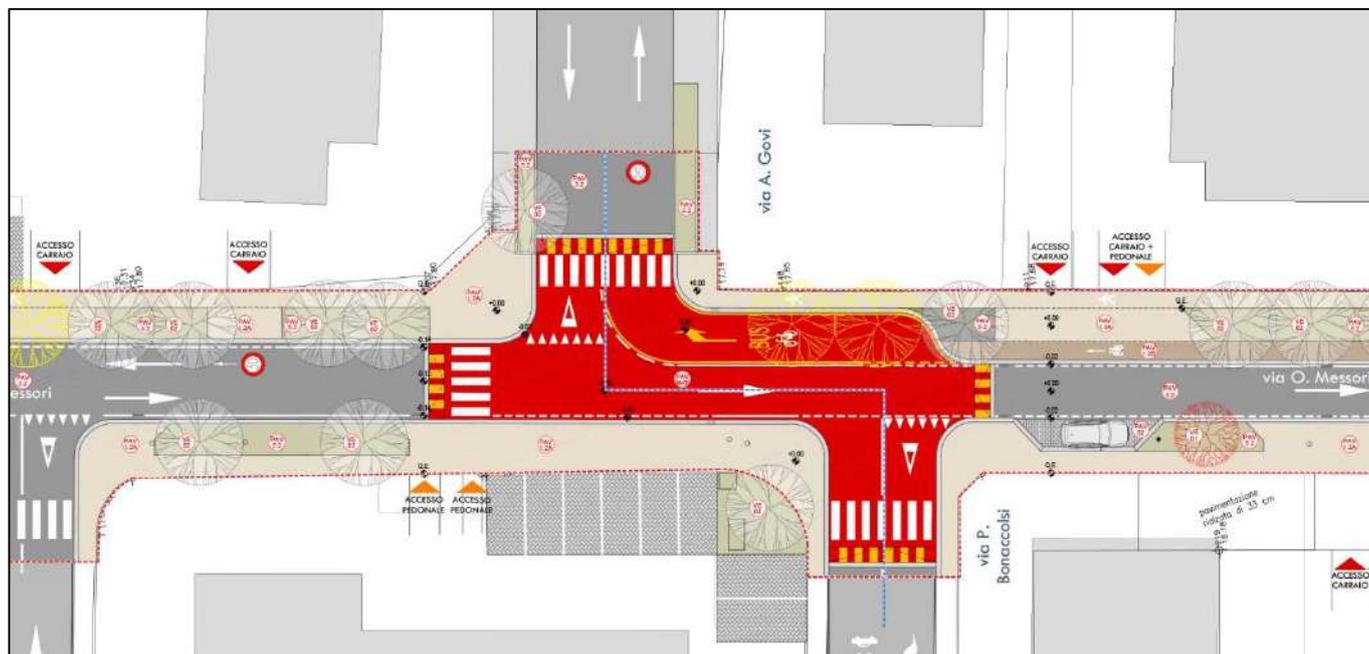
estratto planimetria di progetto via Govi-via Bonaccolsi
